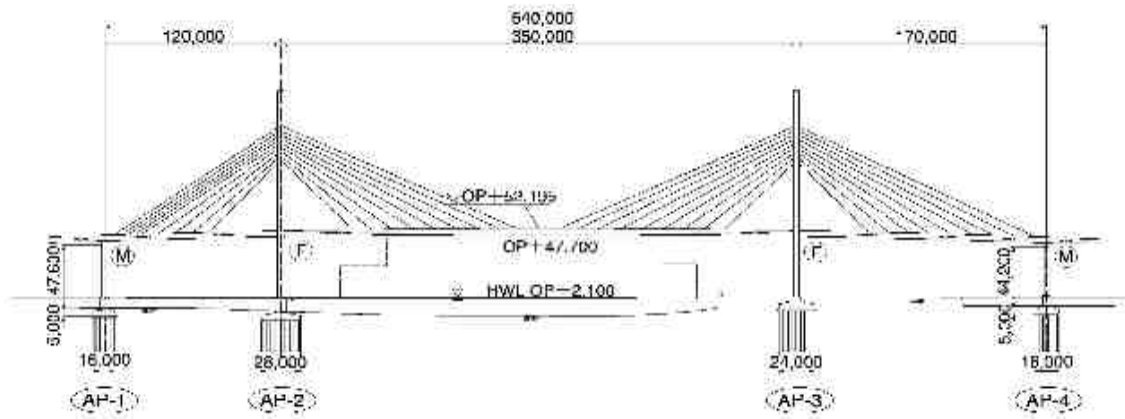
Elevation general puente Tempozan, Kobe, Japón (Iemura y Pradono, 2004)
